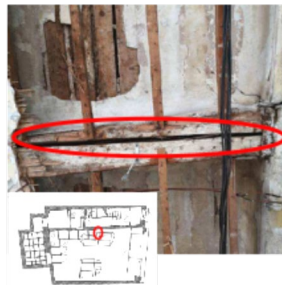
RdC – Vue de la structure du plancher au niveau de l'appui d'une poutre
